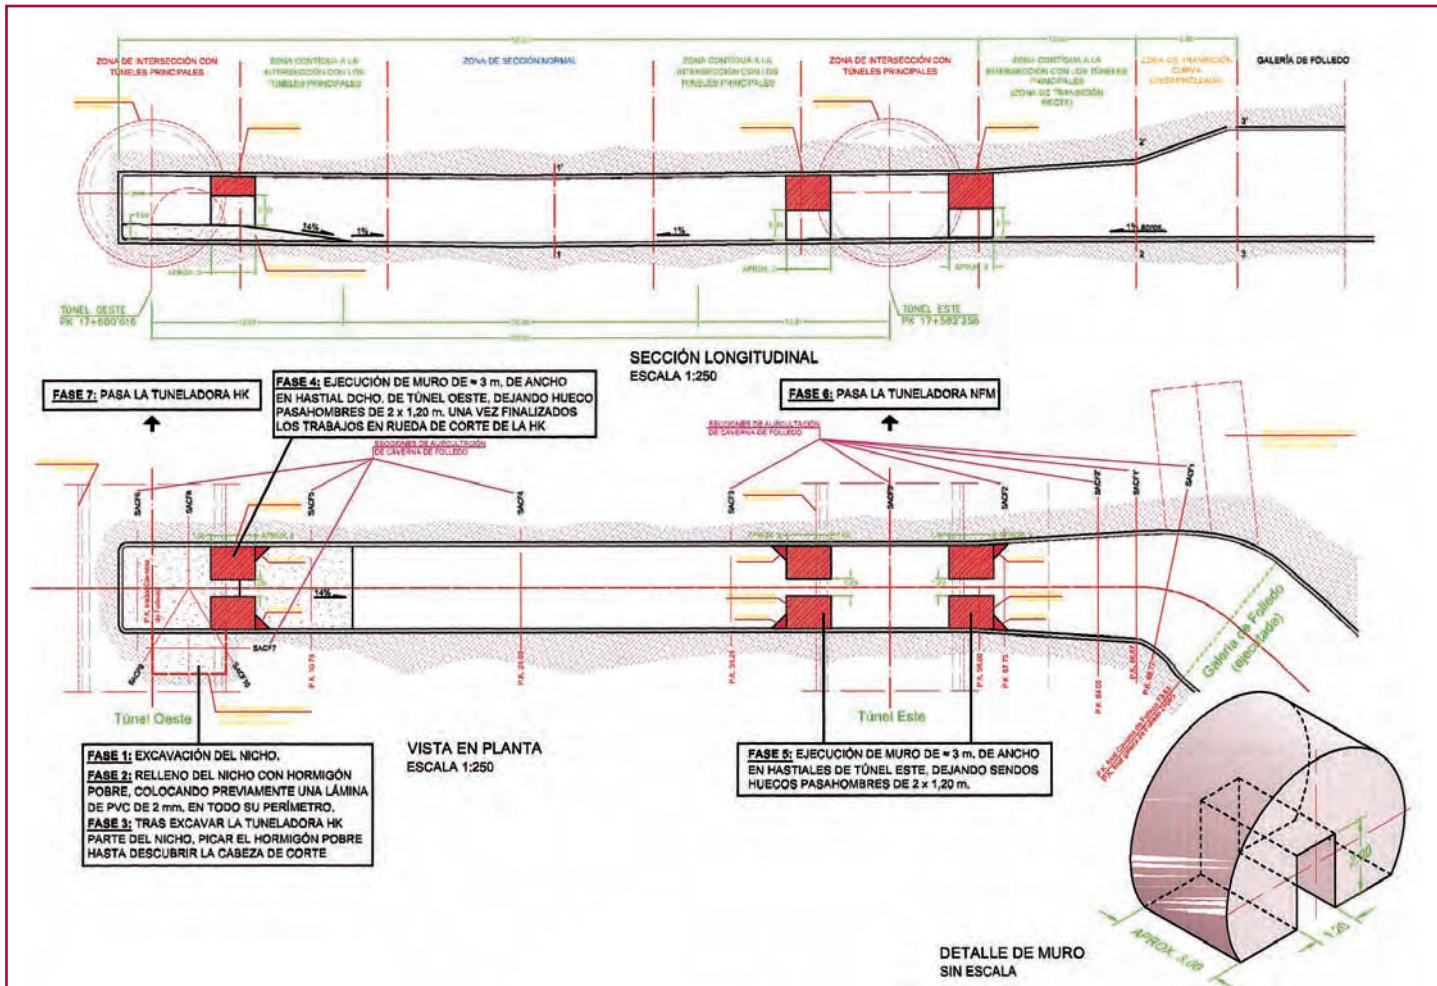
Planta y perfil longitudinal del entronque de la galería de Folledo con los Túneles de línea/Breakthrough point in the Folledo cavern by the TBM on the West tunnel.
